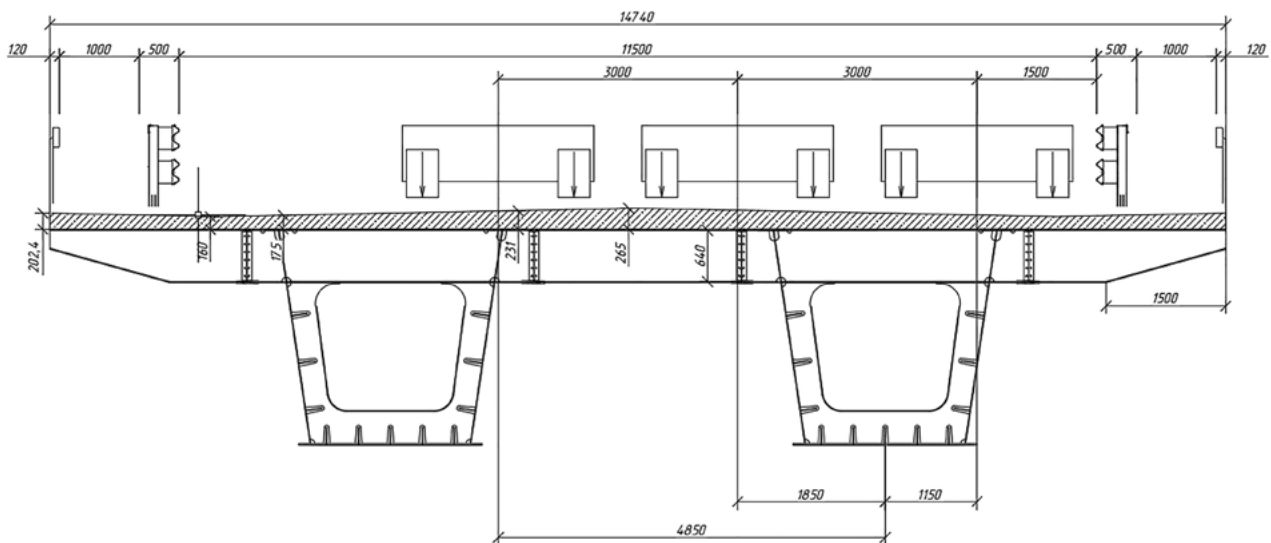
Схема загрузки поперечного сечения полосами нагрузки АК
